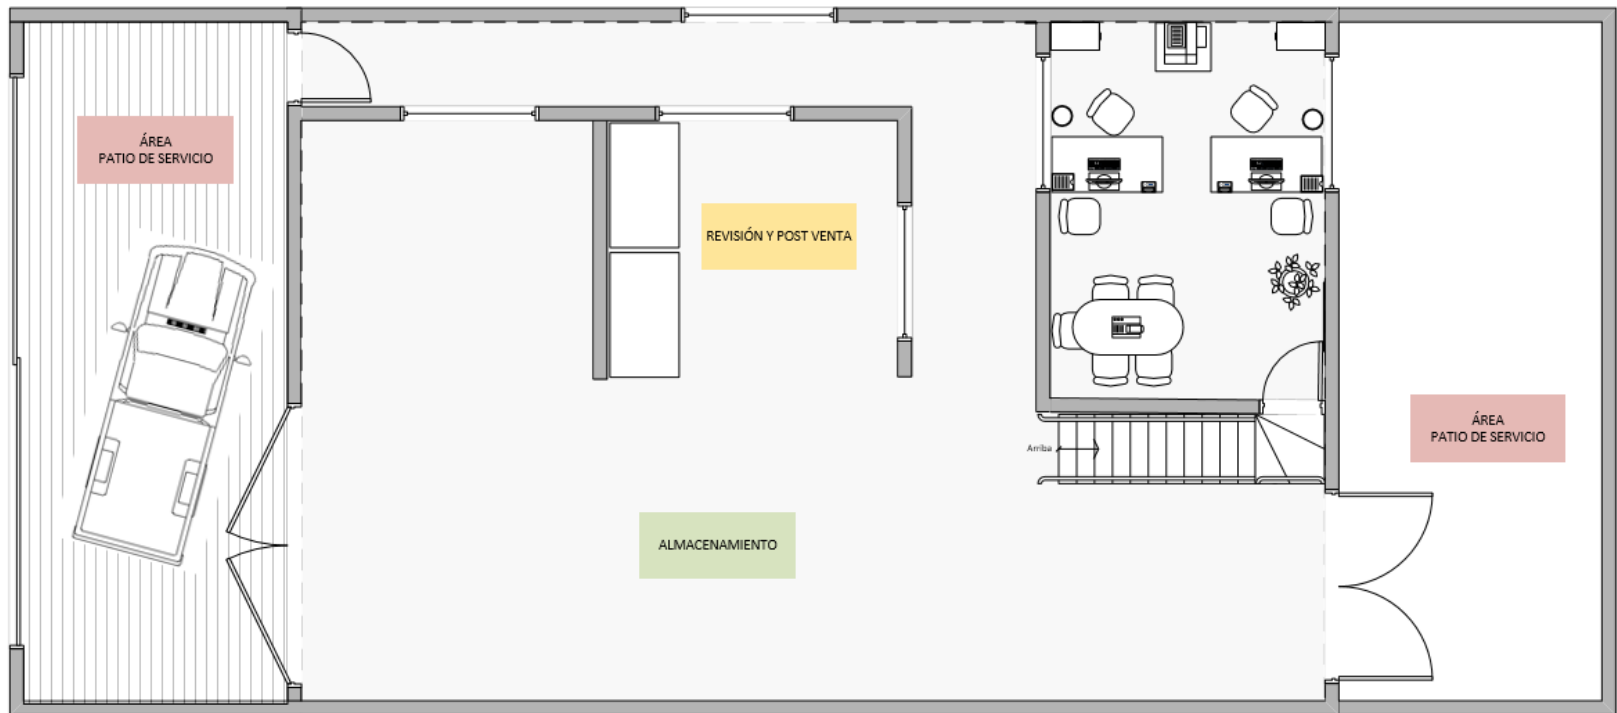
Lay Out de las Bodegas y Oficinas - Planta 2
